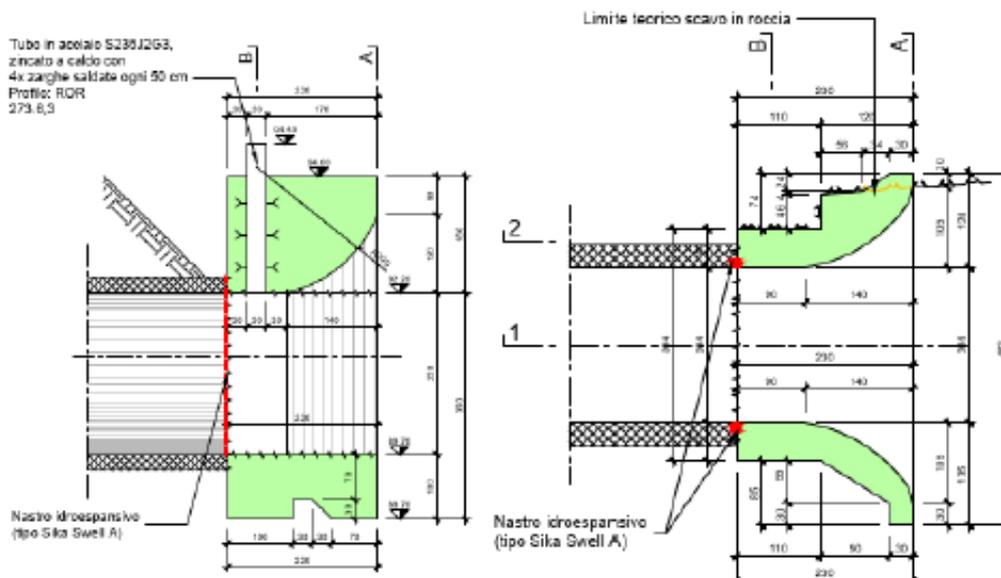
sezione verticale e orizzontale nel nuovo manufatto
